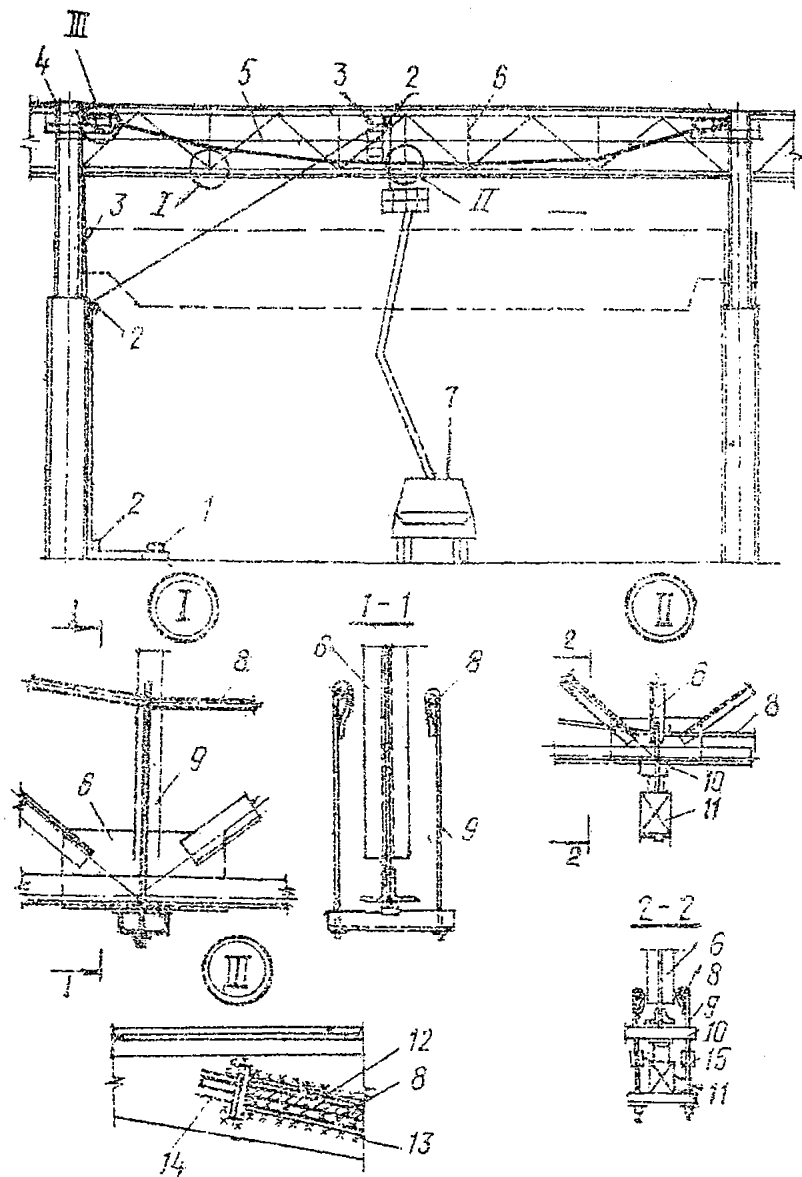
Схема усиления ферм предварительно-напряженными затяжками:
